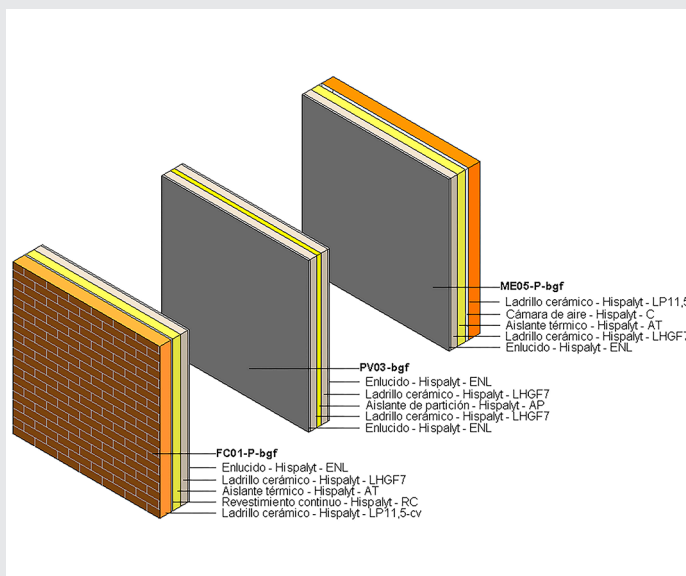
Objetos BIM de fachada, partición vertical y medianería de HISPALYT, con sus componentes.
